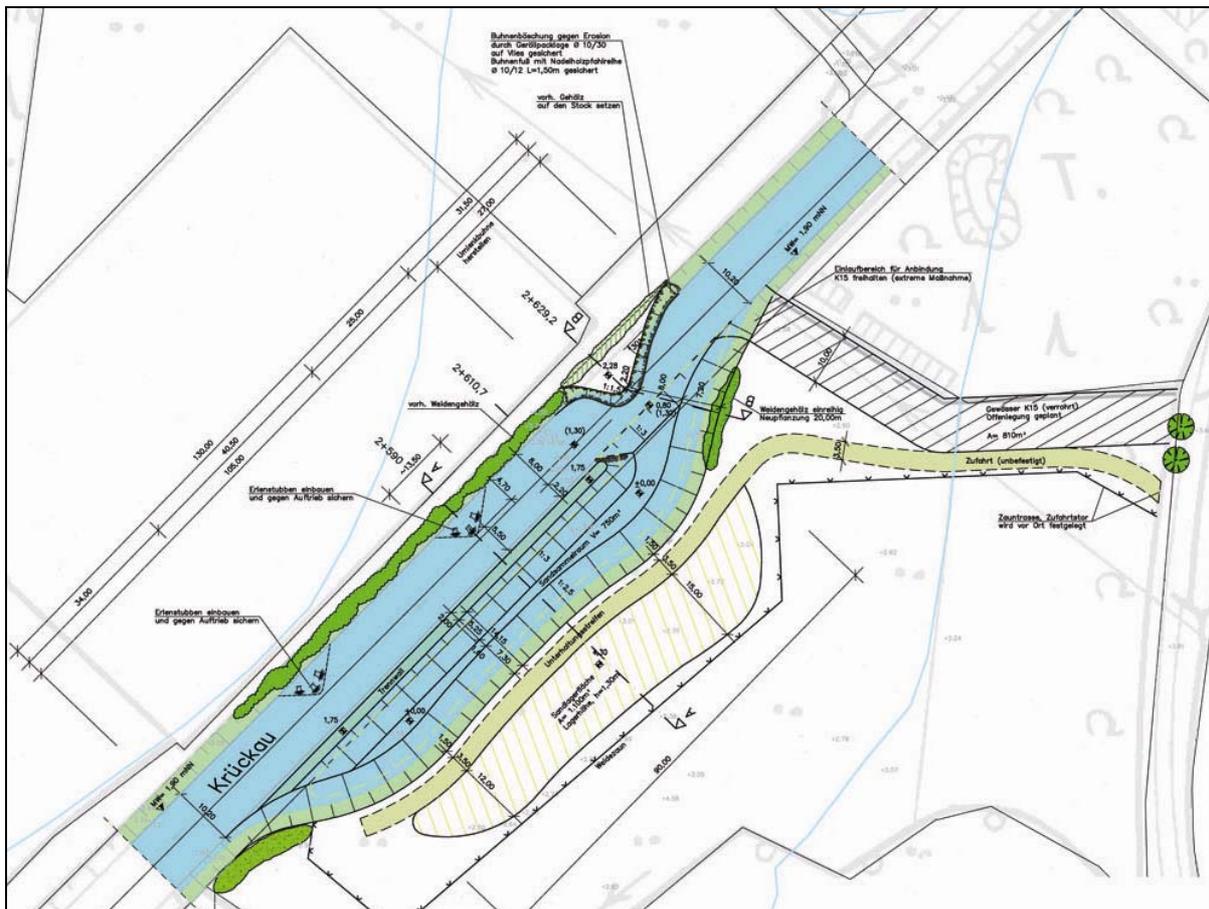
Sandfang im Nebenschluss an der Krückkau 2005, Grundriss (Auftraggeber: Wasserverband Krückkau, Förderstelle für das Land SH: Staatliches Umweltamt Itzehoe, Genehmigungsbehörde: Kreis Pinnberg, Planaufstellung und Bauüberwachung: Ingenieurgemeinschaft Klütz & Kollegen GmbH)
